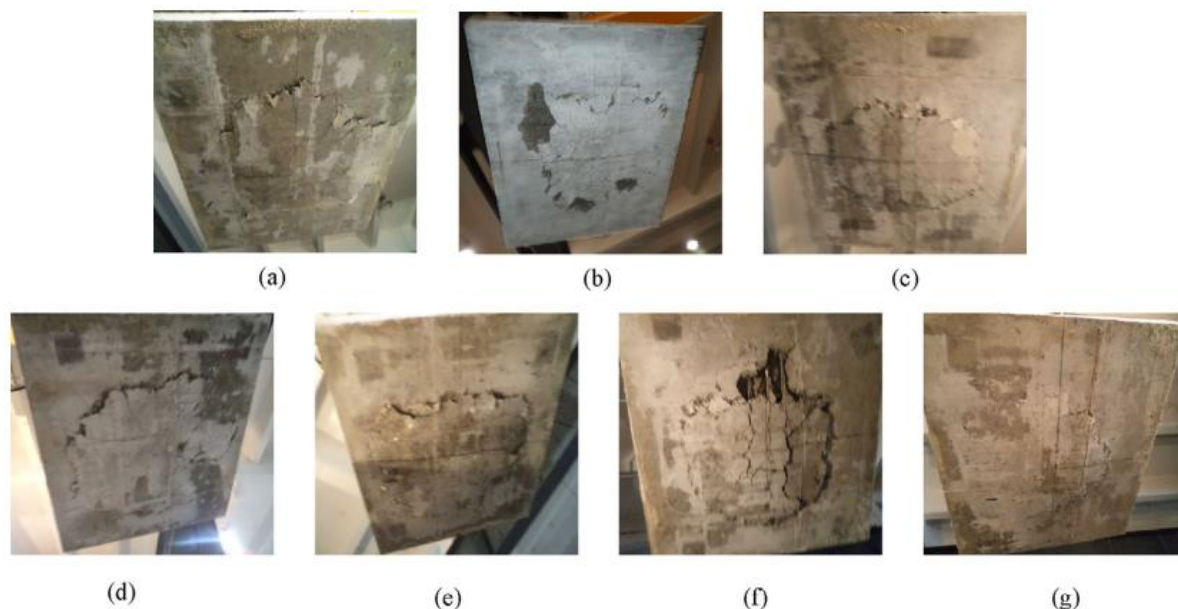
Falha de perfuração das lajes de concreto “RAC0” (a); “RAC50-0%” (b); “SFRAC50-0,5%” (c); “SFRAC50-1,0%” (d); “RAC100-0%” (e); “SFRAC100-0,5%” (f); “SFRAC100-1,0%” (g) (XIAO et al., 2019).
